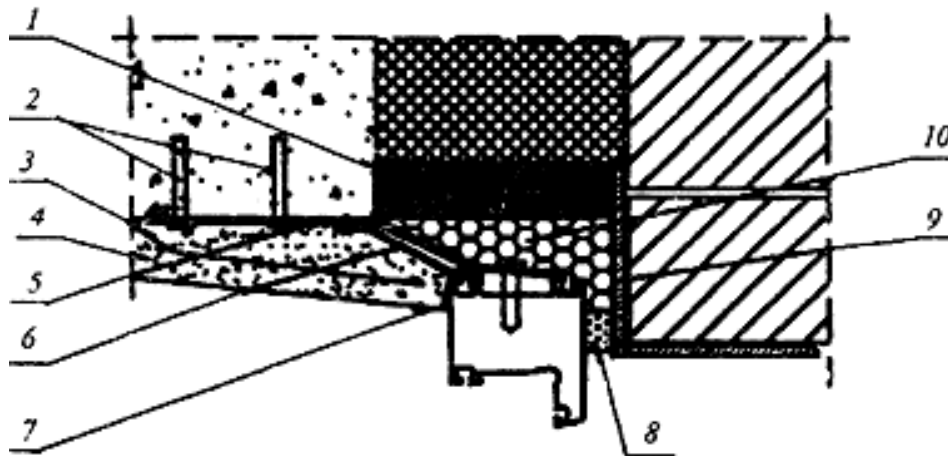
Узел верхнего примыкания оконного блока к перемычке из стального уголка в проеме многослойной стены с облицовкой кирпичом:
